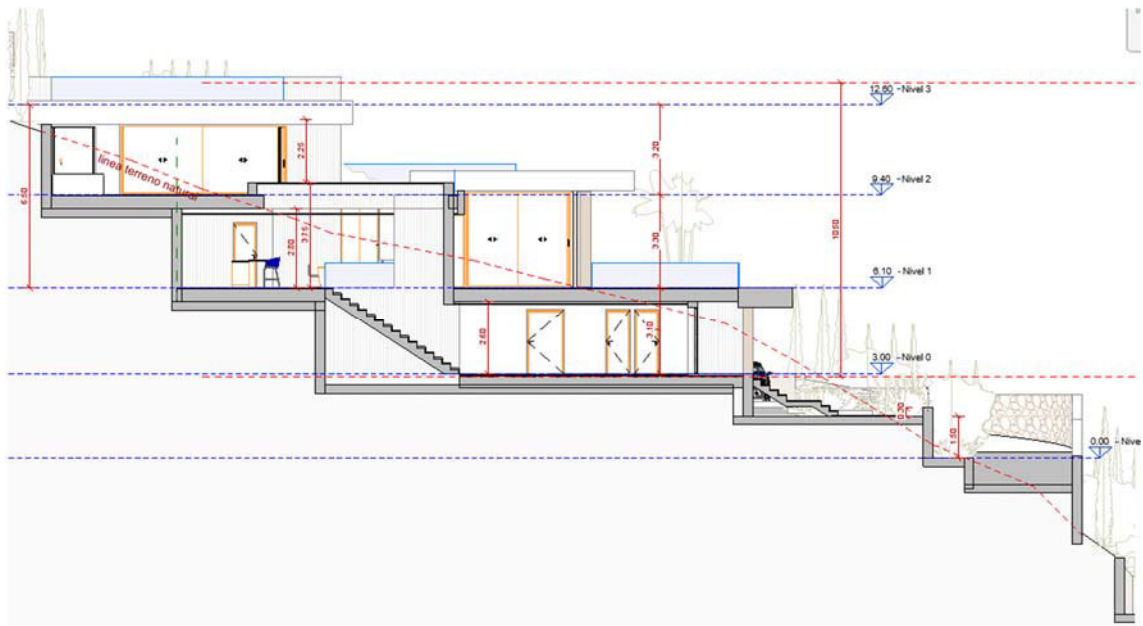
SECCIÓN TRANSVERSAL POR ESCALERA DE N.-1 A N.0
